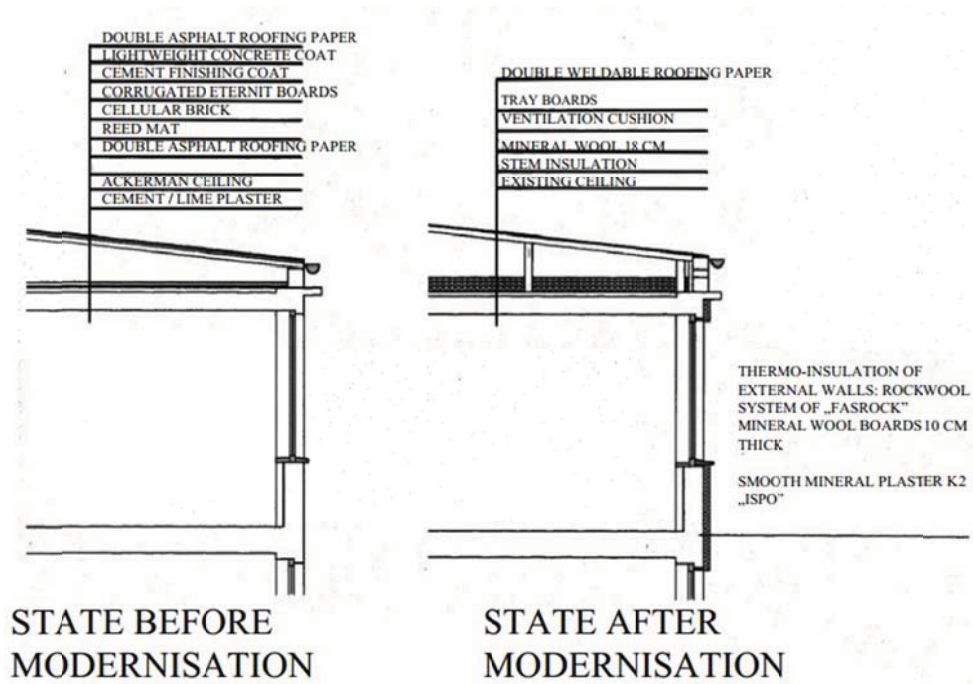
Sezione dell’ospedale prima e dopo la ristrutturazione.
